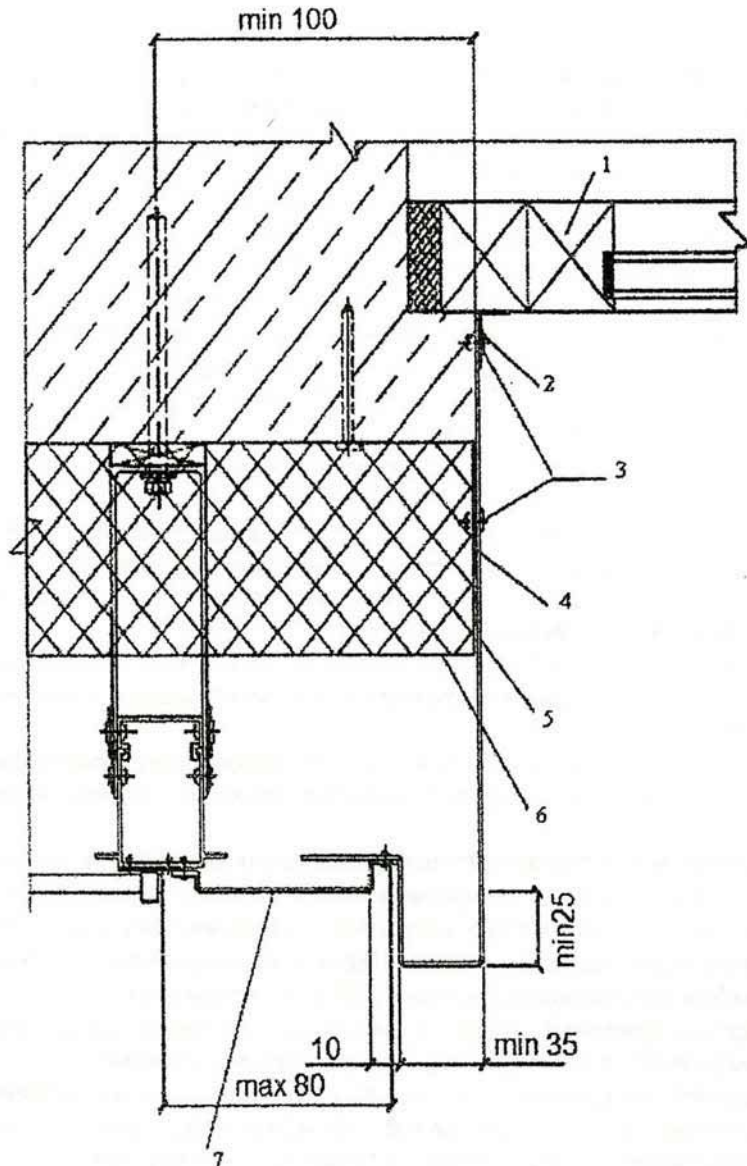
Установка нащельника в местах примыкания к оконным проемам и балконам:
